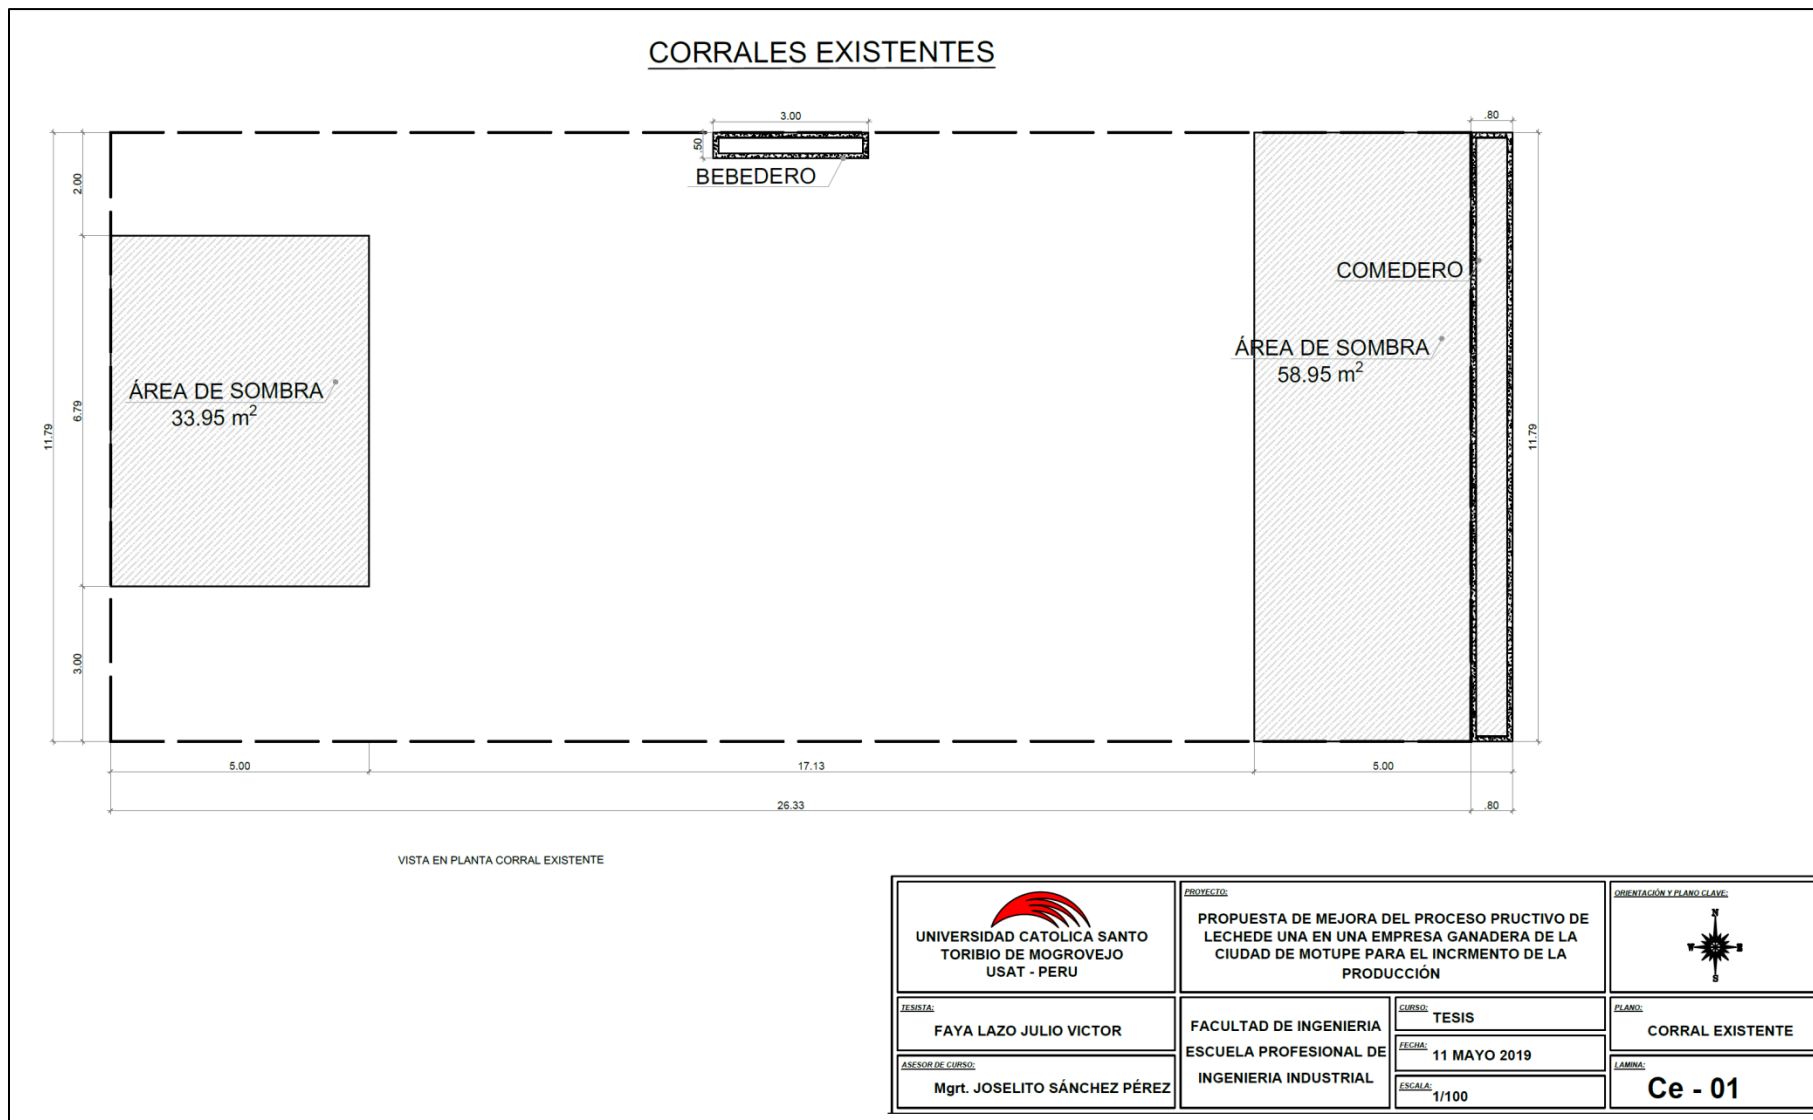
Proporción de sombra proyectada y ubicación de bebederos en corrales - Vista en planta
